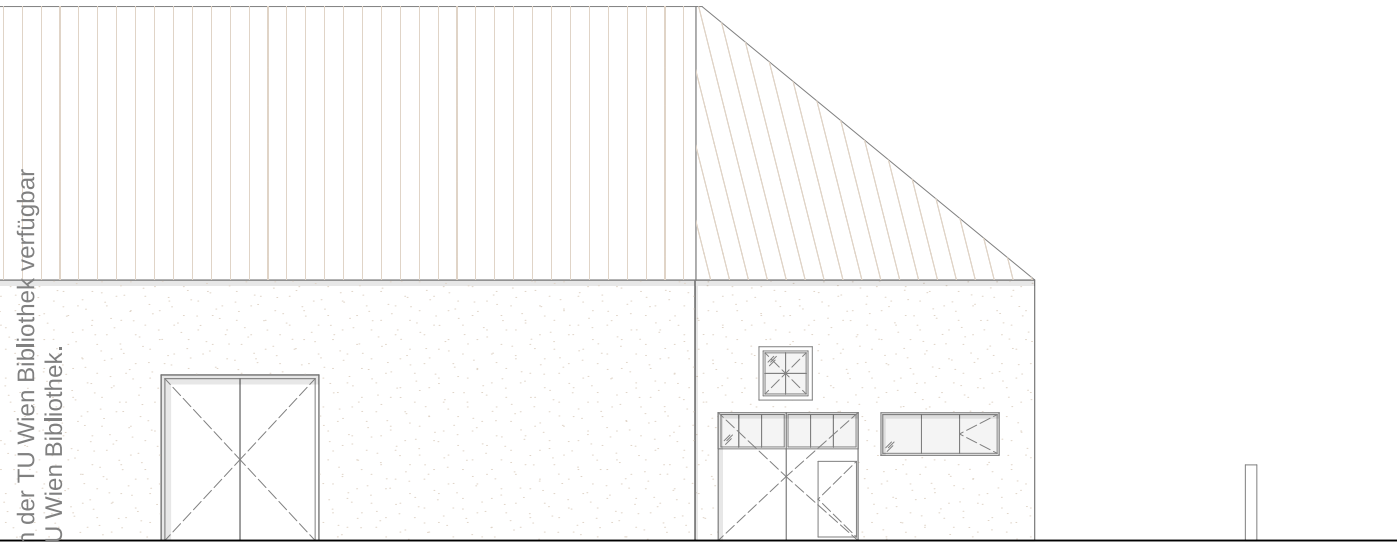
Bestandsgebäude Halle, Hofansicht Nordwest, M. 1:200
